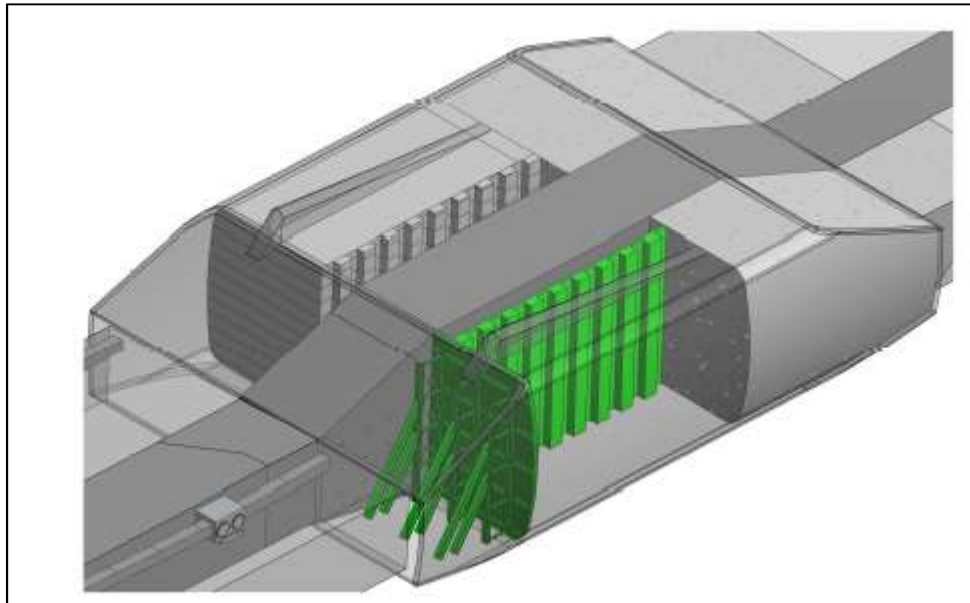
Vue en perspective d'un coffrage pour un barrage double
